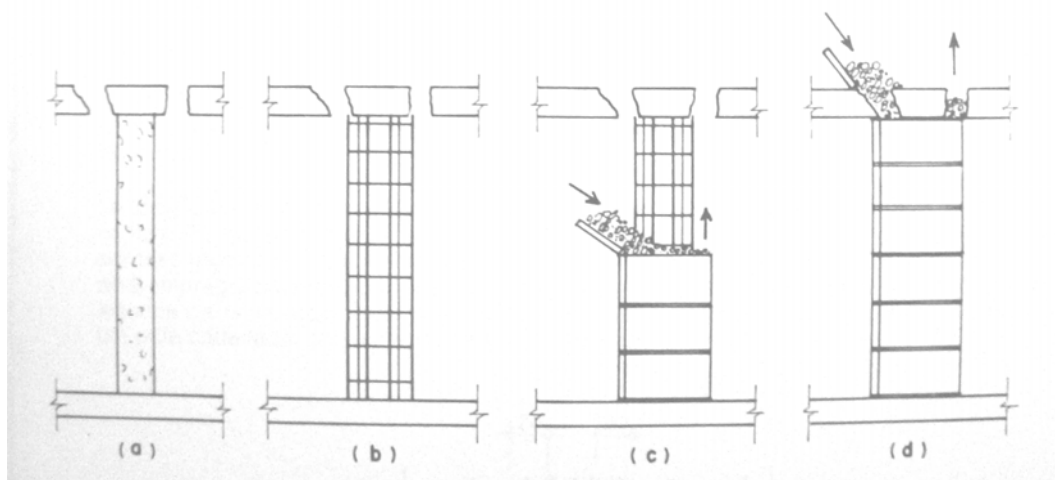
Reforço de pilar com concreto e armaduras suplementares
